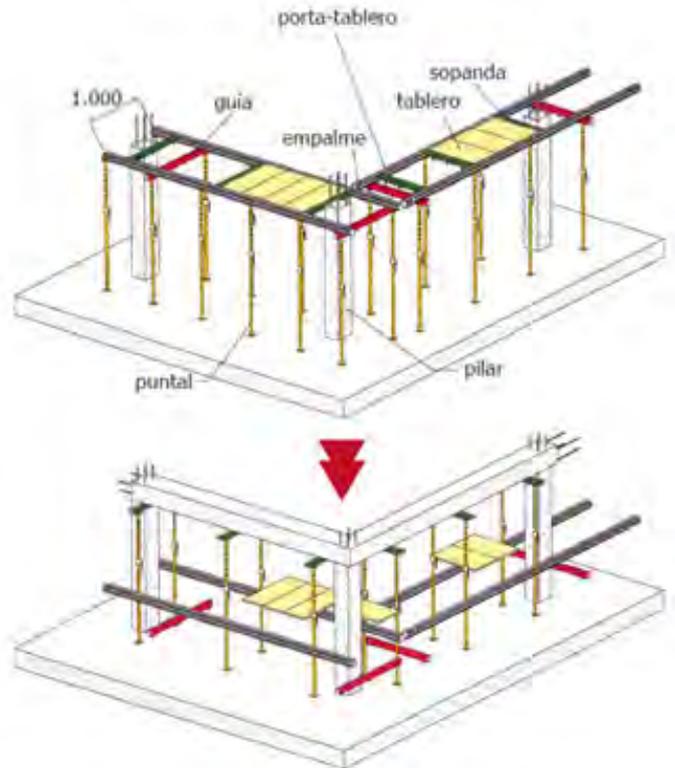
Sistema de encofrado mediante sopandas para forjado de vigas planas unidireccionales.
